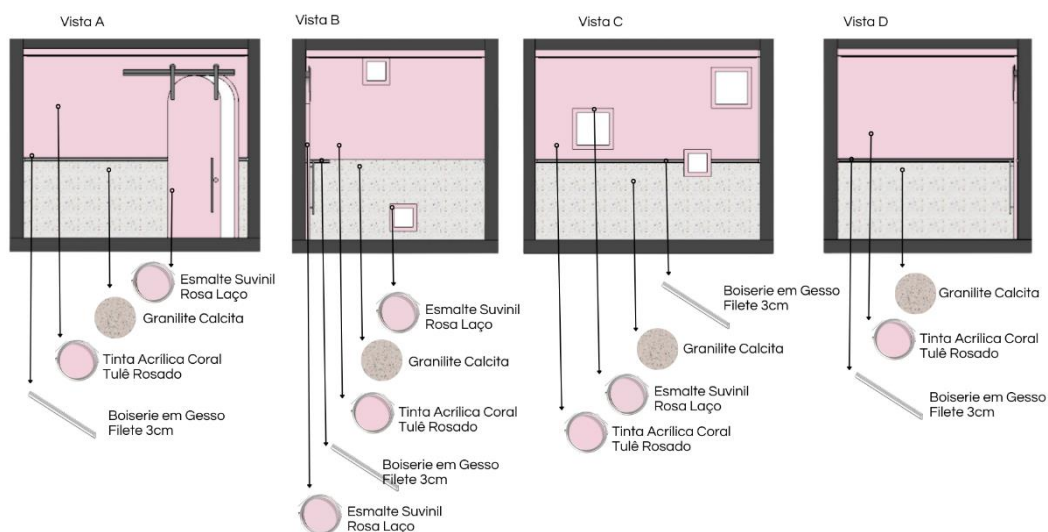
Banheiro Nuvem: Planta Baixa dos Acabamentos
